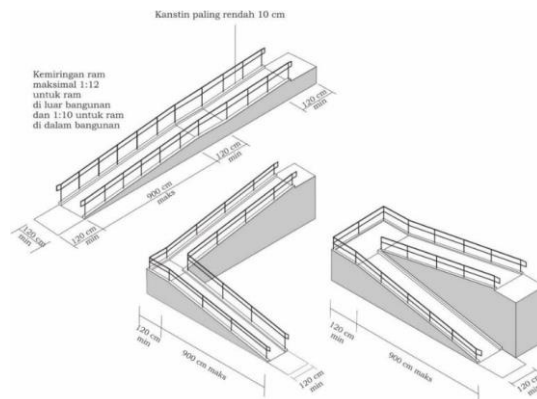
Pegangan rambatan (*handrail*) yang direkomendasikan
